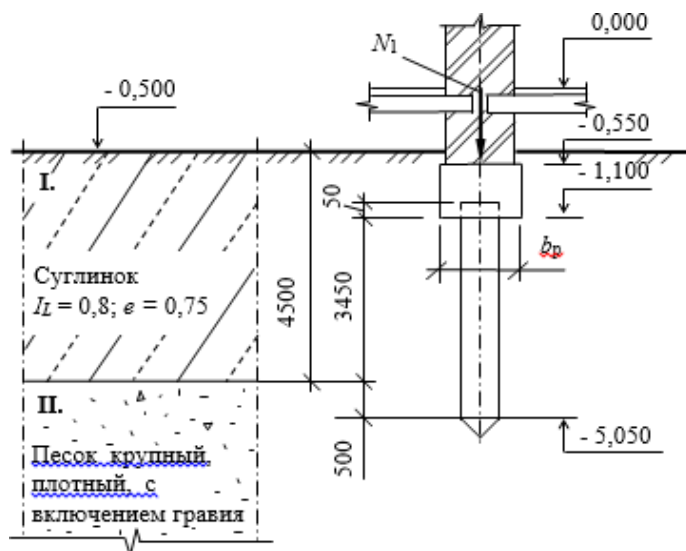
Свайный фундамент и грунтовые условия к примеру
